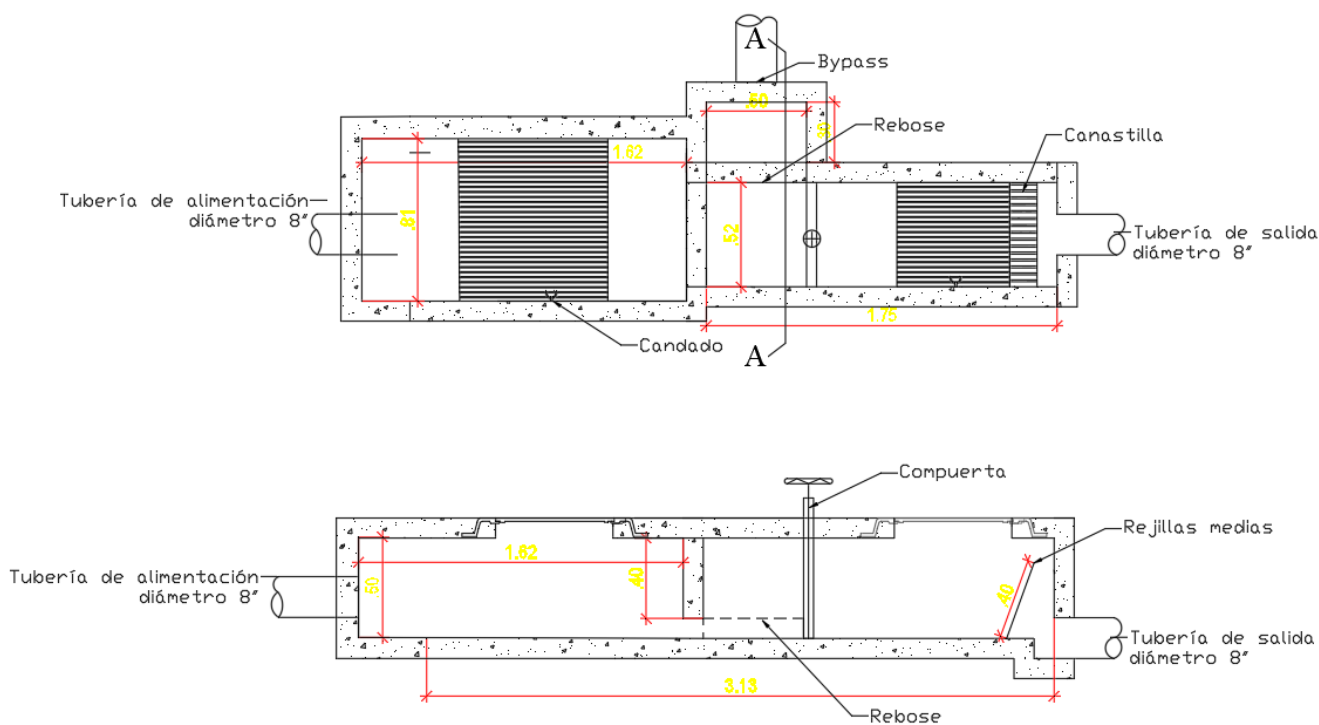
Vista planta y perfil canal de entrada y rejilla
